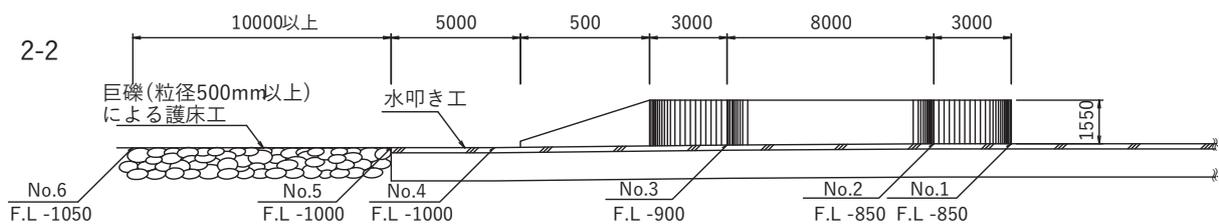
土砂吐きの縦断面図例<sup>3)</sup>
